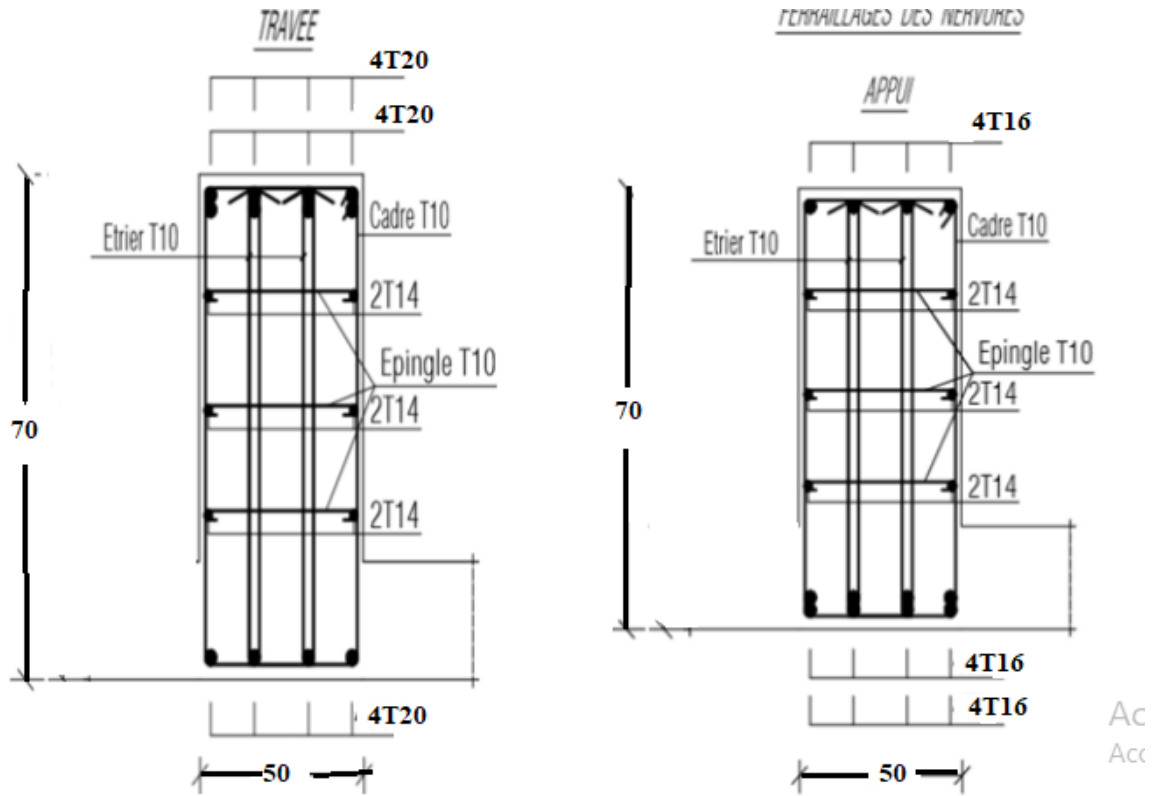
Ferrailage des nervures suivant X-X.
